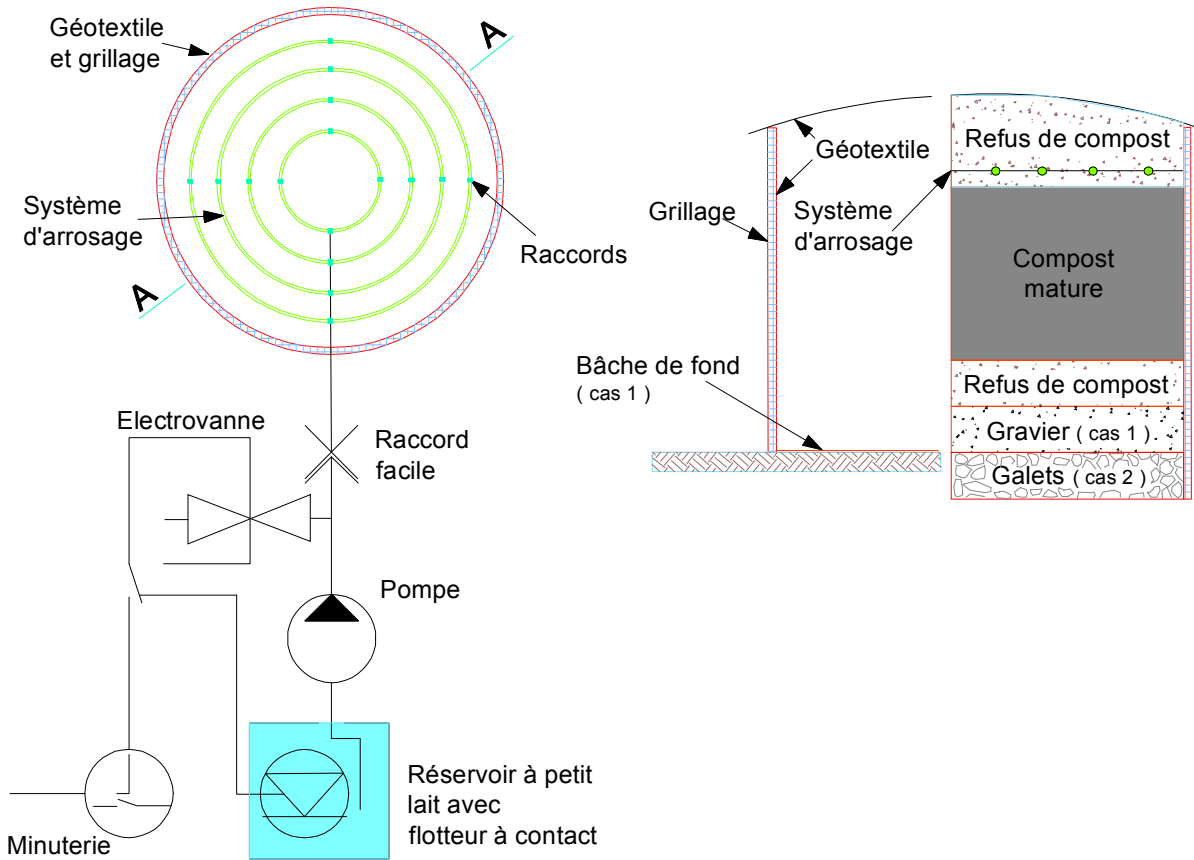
Schéma bloc, construction d'un dispositif de forme circulaire et dispositif de régulation
